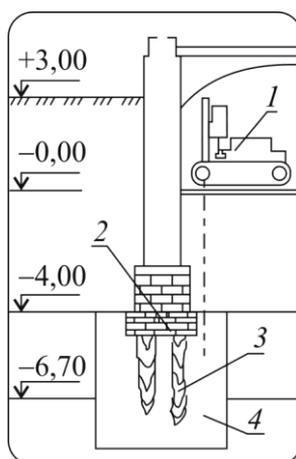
Усиление основания памятника военной архитектуры в Вене (казармы Россауэр); 1 – буровой станок SC-1 (Keller); 2 – существующий фундамент; 3 – деревянные сваи; 4 – укрепленные массивы грунта
